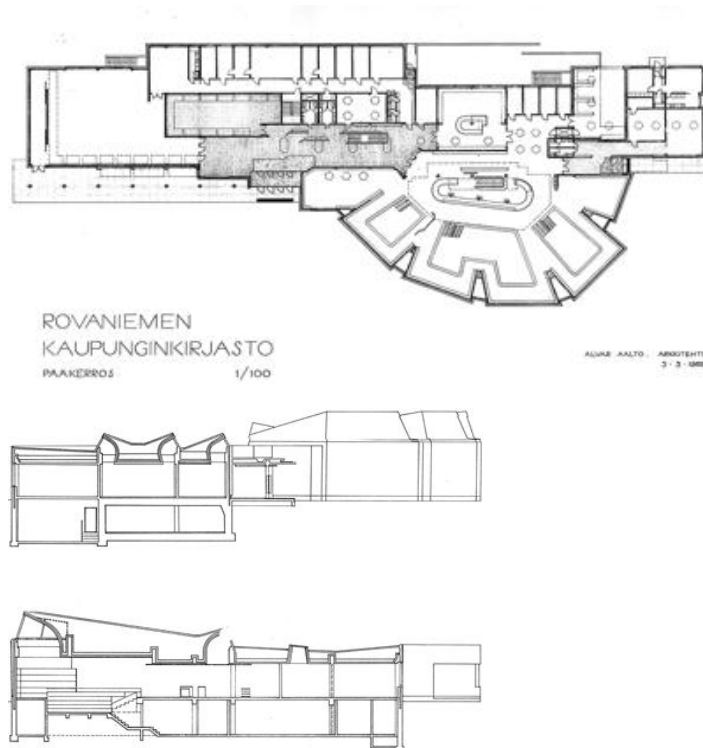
Planta e Cortes da Biblioteca de Rovaniemi, 1963-1968. Alvar Aalto
